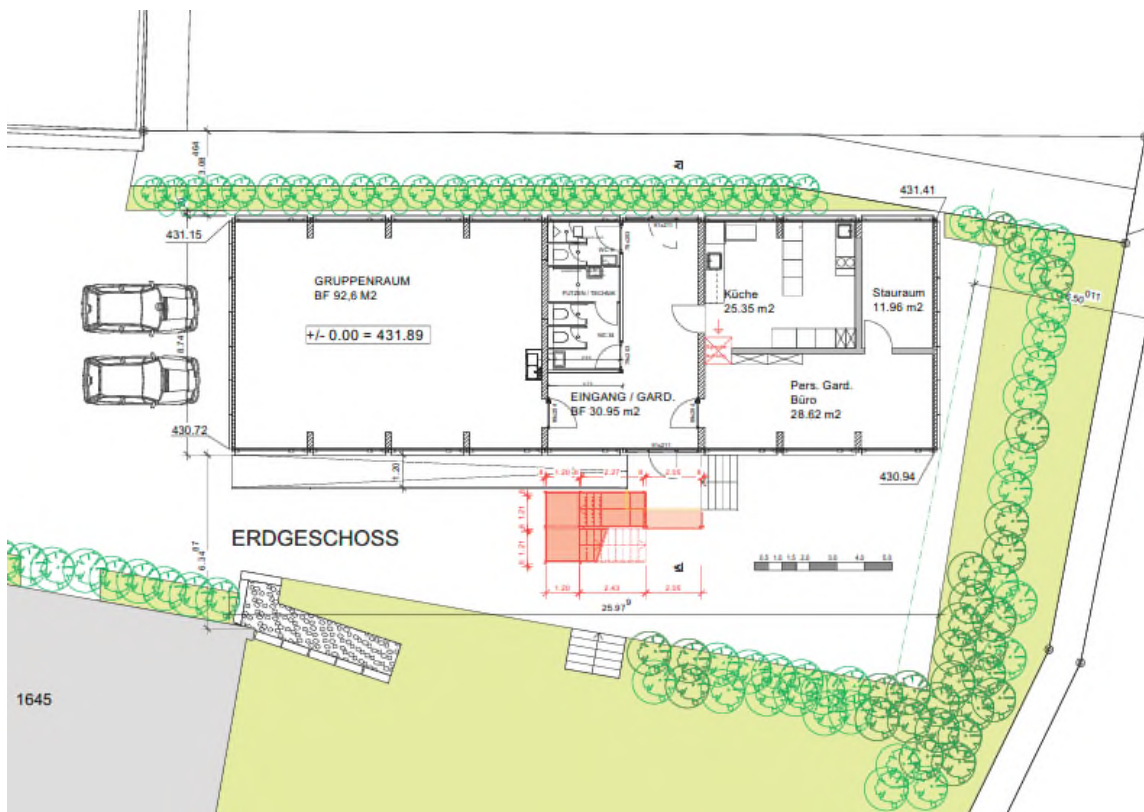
Grundriss Erdgeschoss mit umliegendem Aussenraum
